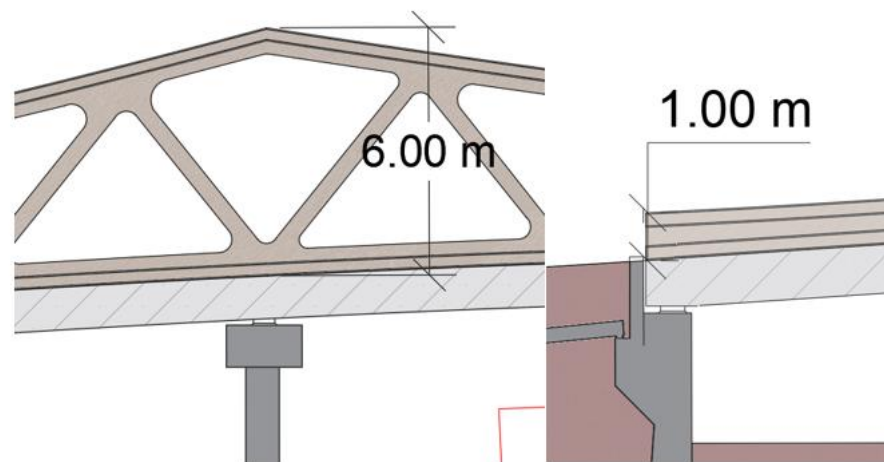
Rebajamiento de la celosía superior en Apoyo central. Detalle del canto en Apoyos extremos.
